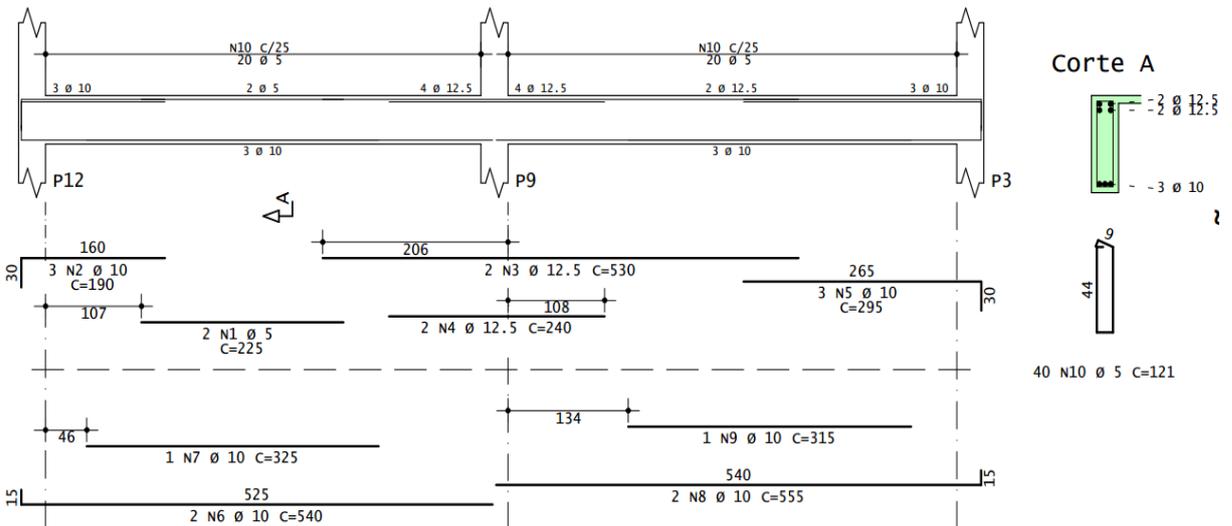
Armadura da viga V9 – pavimento superior (nível +3,00)
